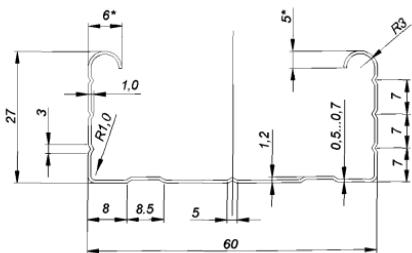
Профиль направляющий П- образный 60x27 (НПП 60x27)
